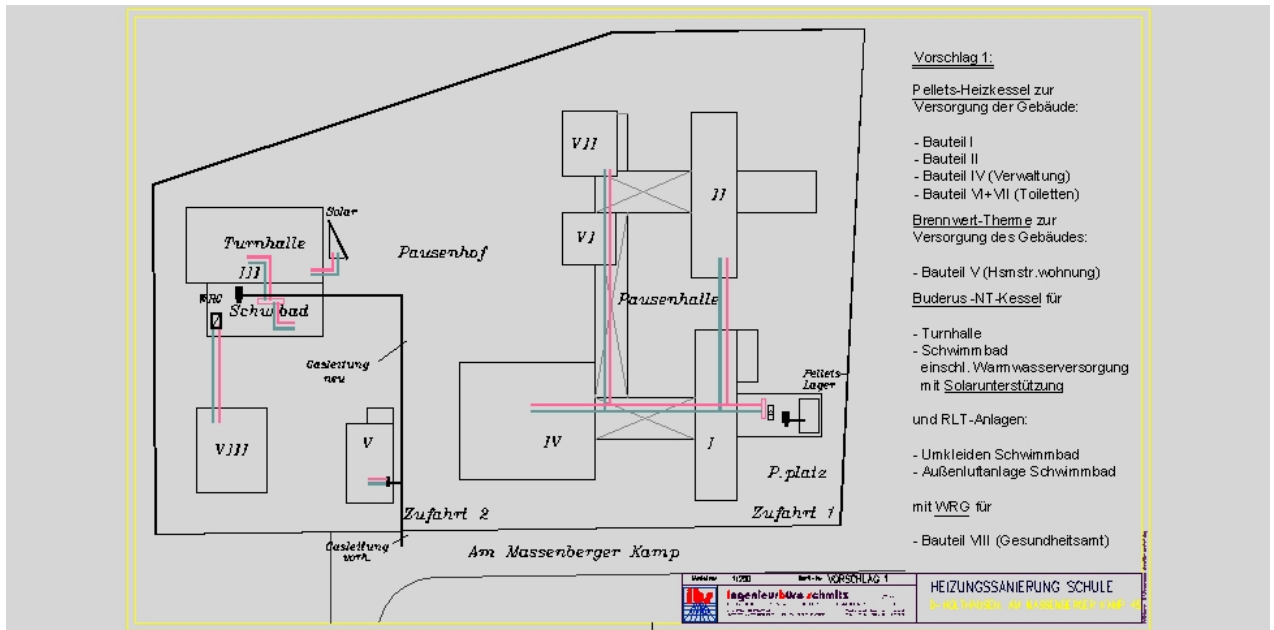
Lageplan mit Wärmeverteilsystem (neu)²
